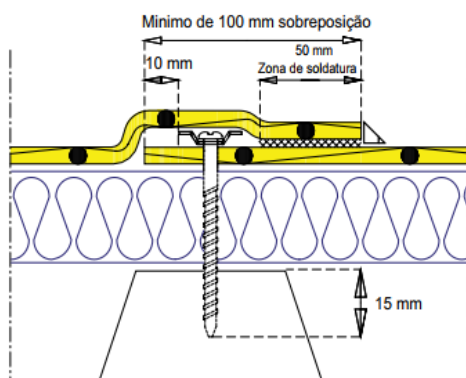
Fixação Mecânica e Sobreposição das membranas em chapas de aço nervurado [Fonte: Renolit Waterproofing]
